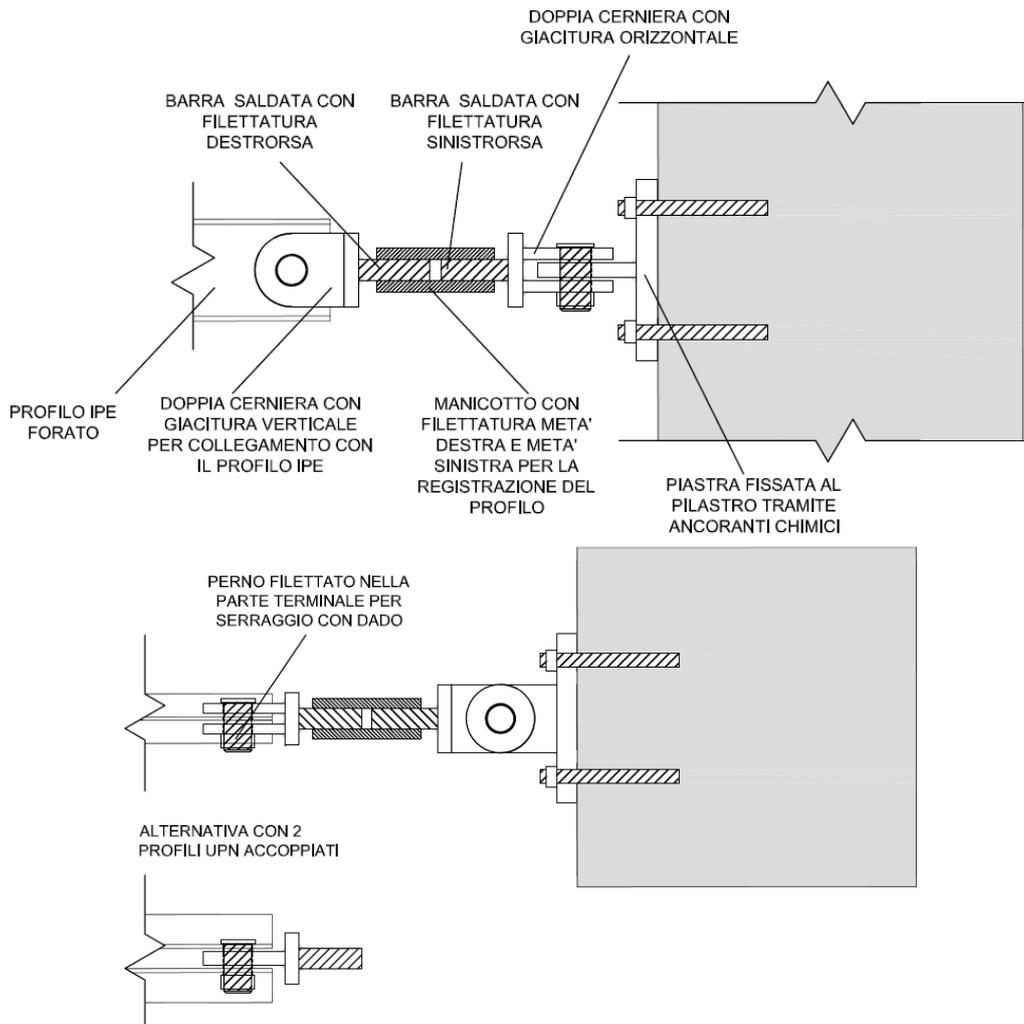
Collegamento dei pilastri tramite profili metallici.
